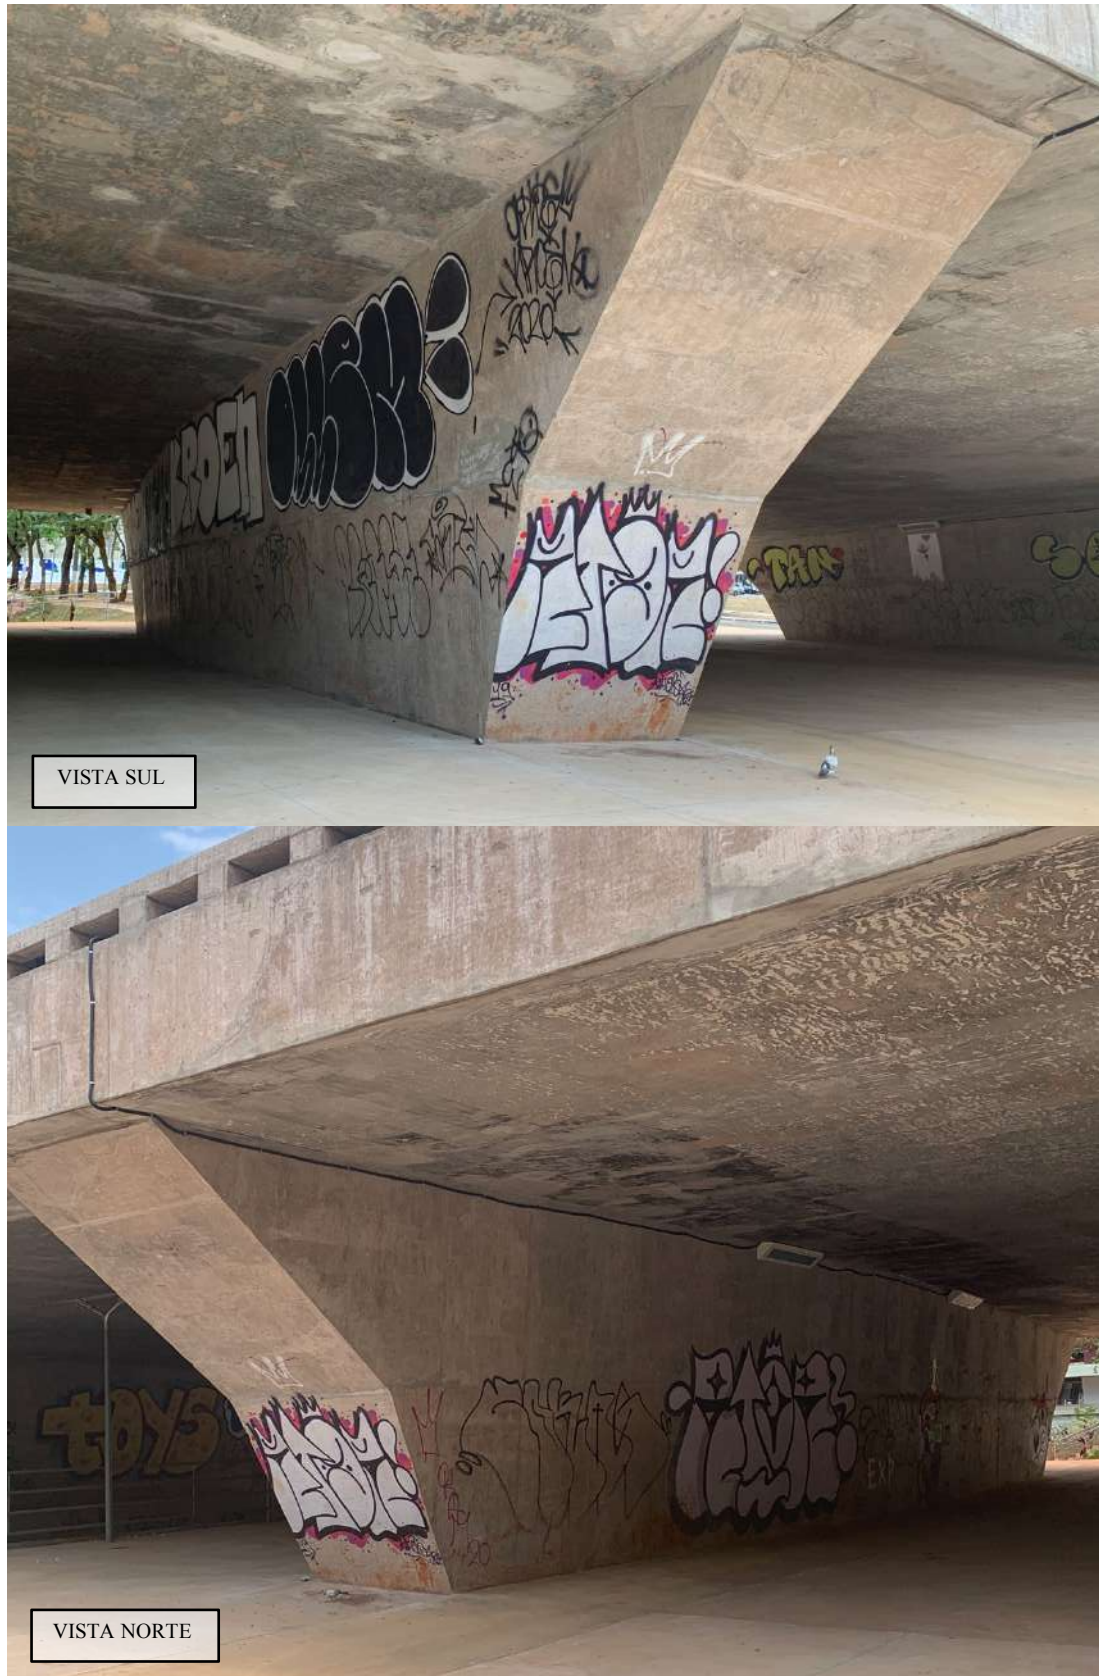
Pilar 5, vistas sul e norte. Fonte: autoral
